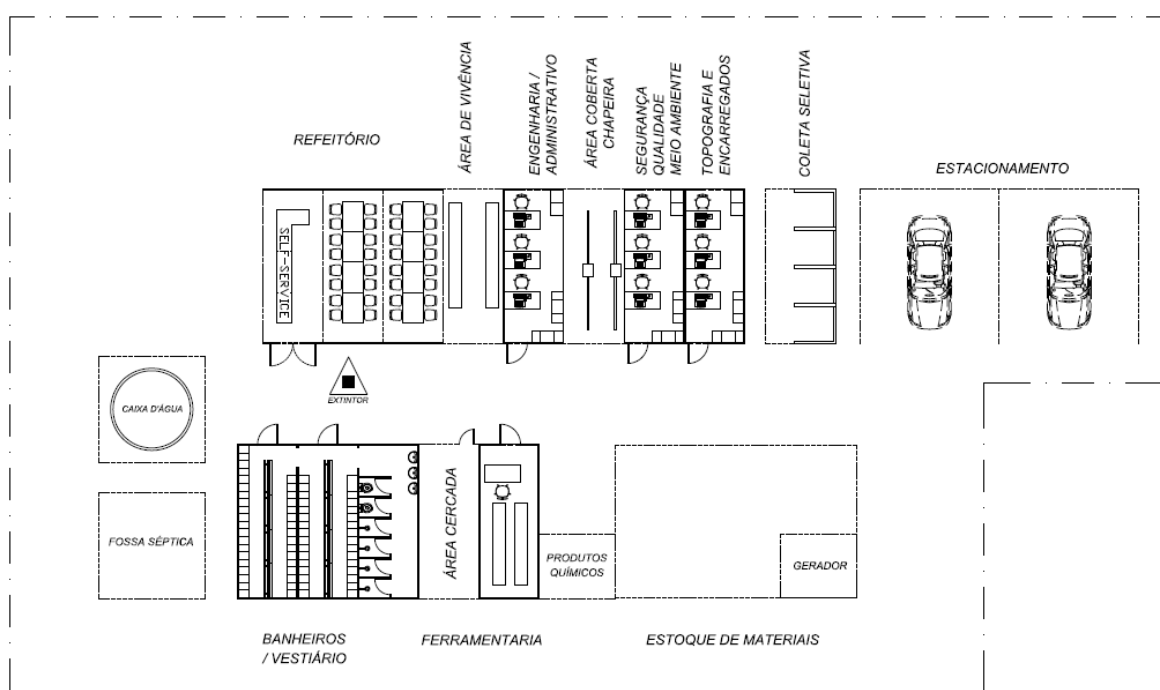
Layout do canteiro da PDE Extrativa.
